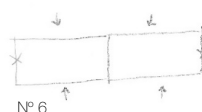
Boceto en planta de la disposición de la construcción situada en la Rúa Vilagarcía de Arousa, nº 6 (autoría propia).
